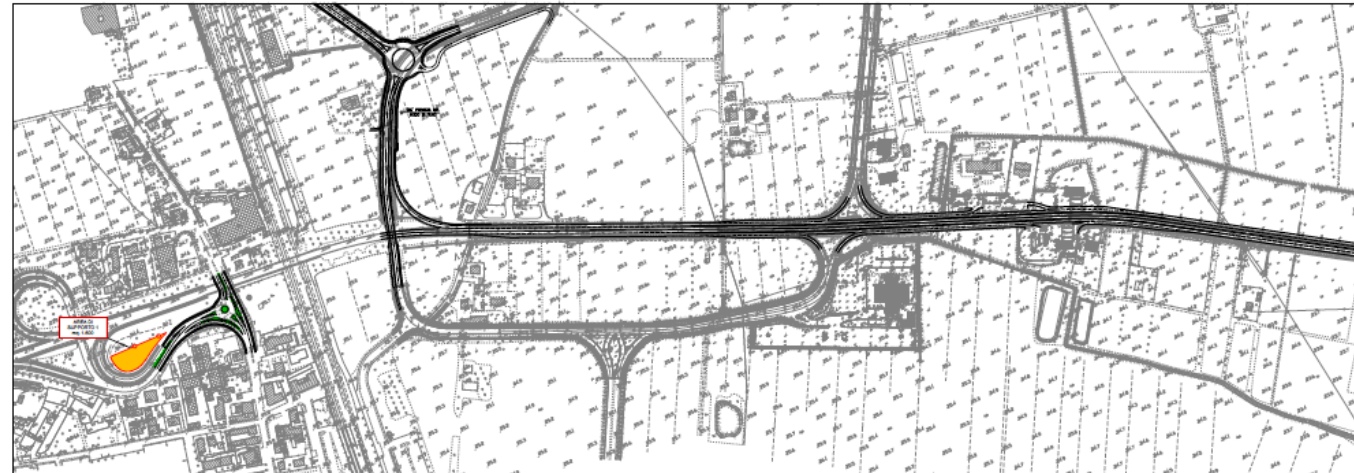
Localizzazione in pianta dell'area di Cantiere ADS01 di superficie 1.600 mq riportata in arancione
